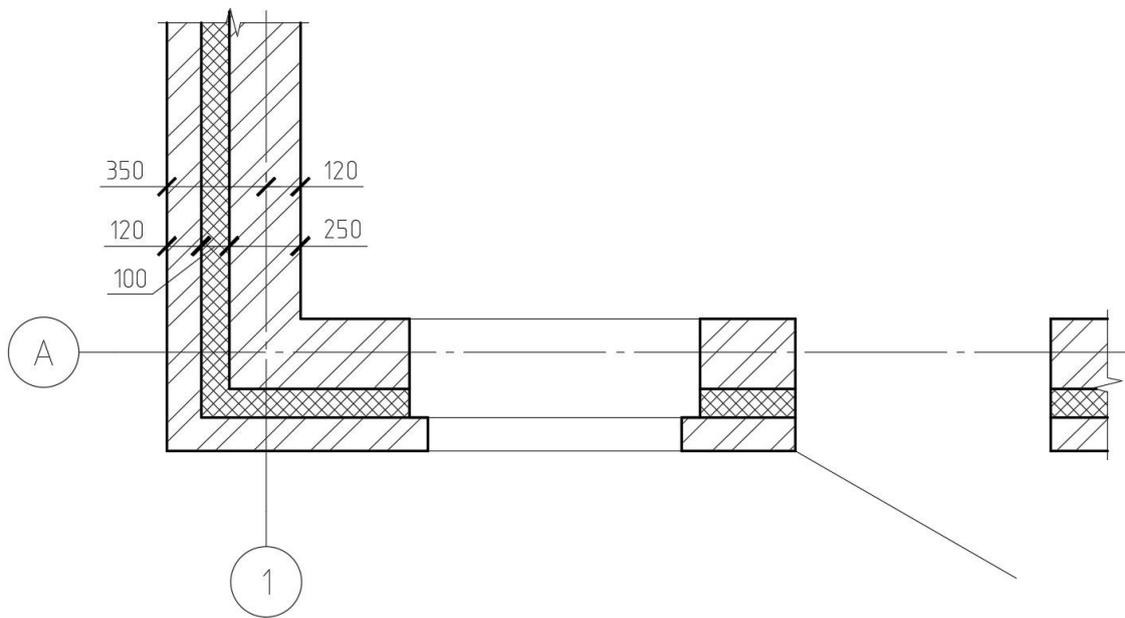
Пример проработки конструкций наружных стен, оконных и дверных проемов для планов этажей
